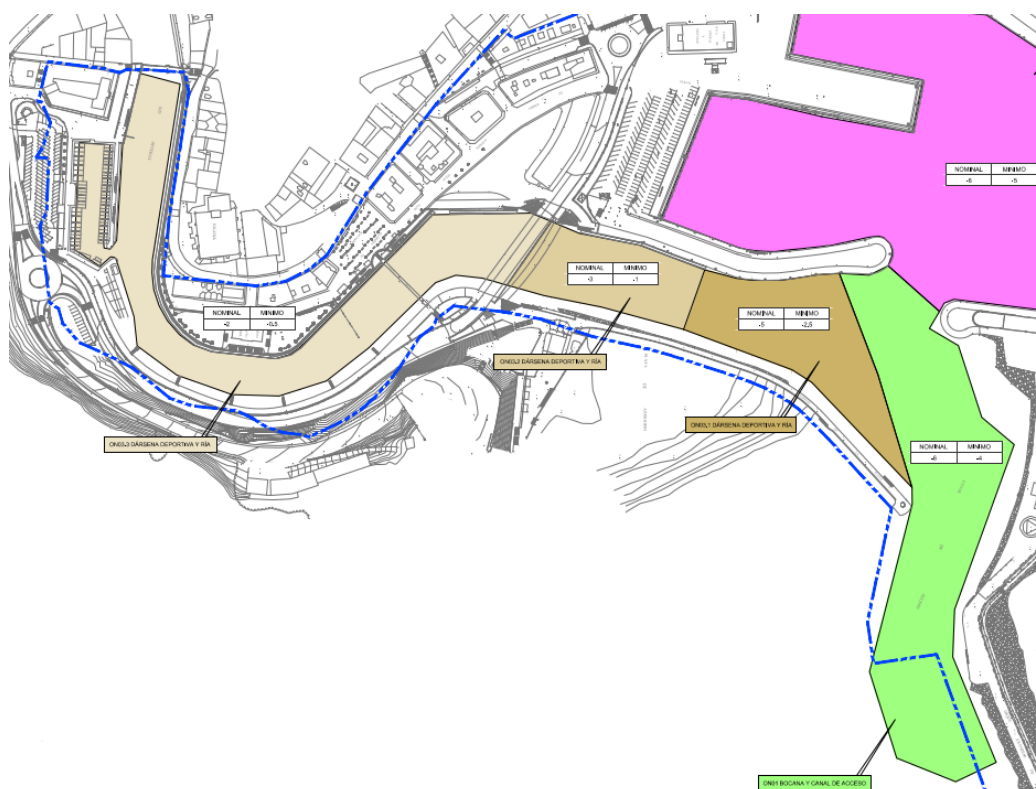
Vista en planta del puerto de Ondarroa. Zonas a draga: bocana y canal de acceso ON01 (verde claro), dársena deportiva y ría ON3.1, ON3.2 y ON3.3 (marrón, de más oscuro a más claro) y dársena Egidazu ON02 (rosa).
